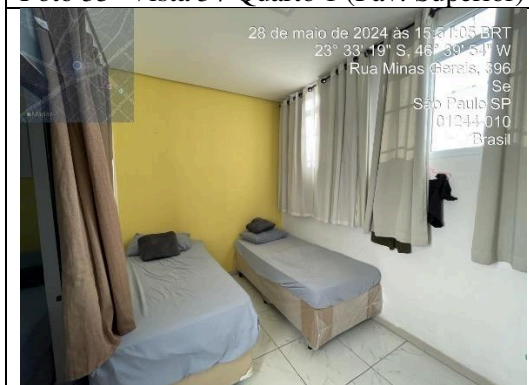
Vista 1 / Quarto 2 (Pav. Superior)
